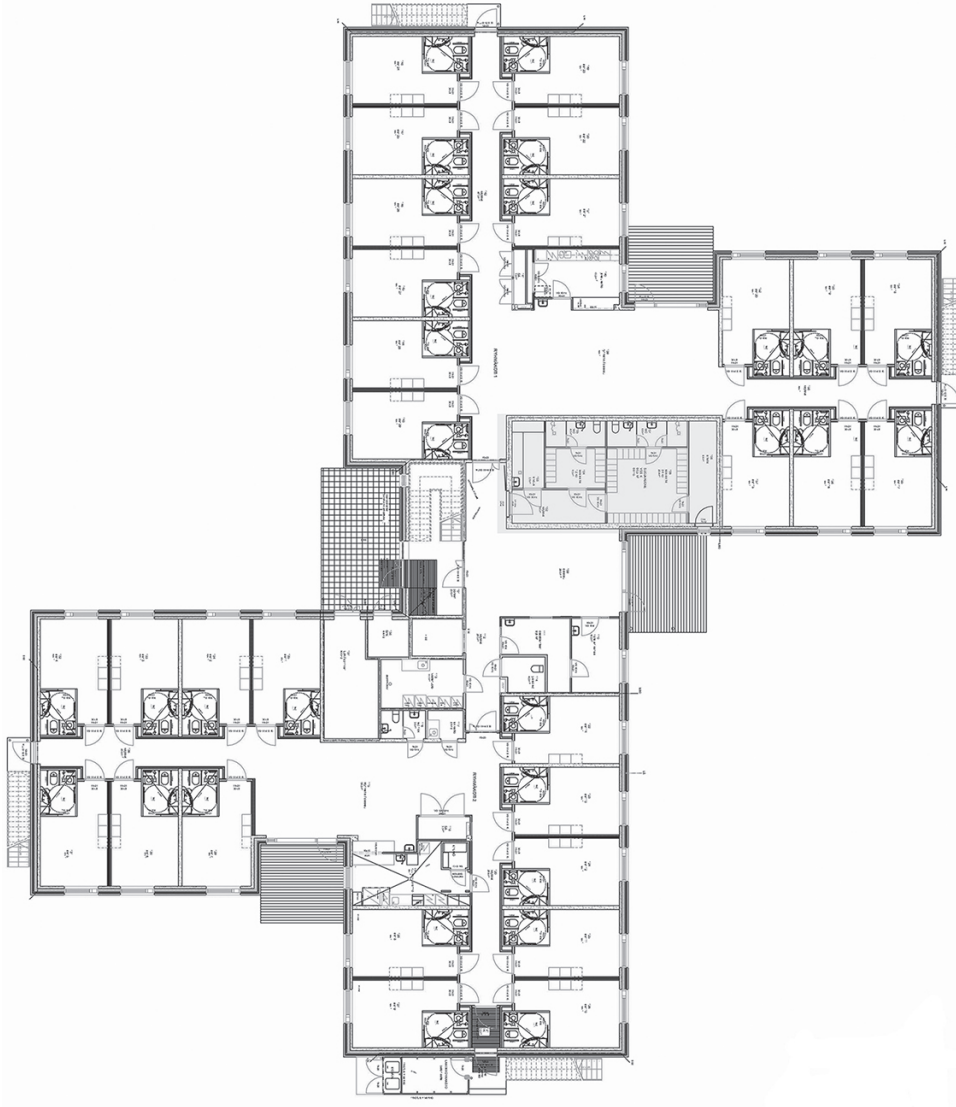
Tässä muuntojoustavassa esimerkkiratkaisussa väliseinät ovat kevyitä, ja pilarit ja ulkoseinät ovat kantavia.
